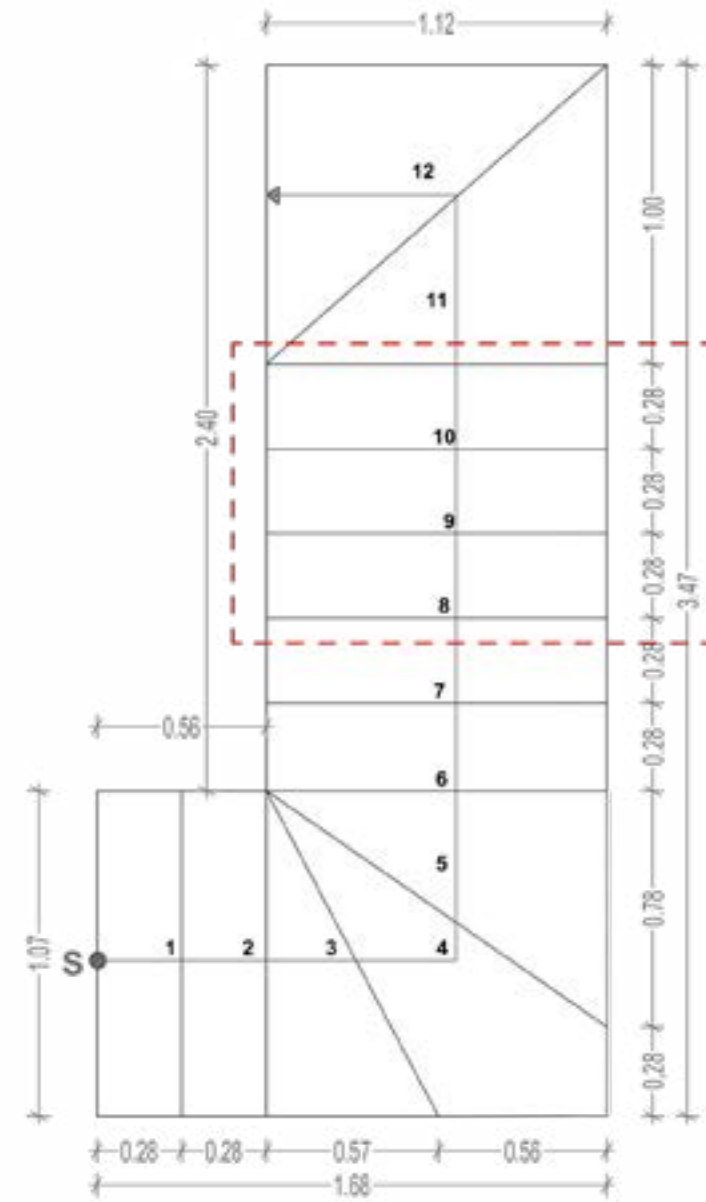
Imágen_Detalle Steel Frame, Gradas
